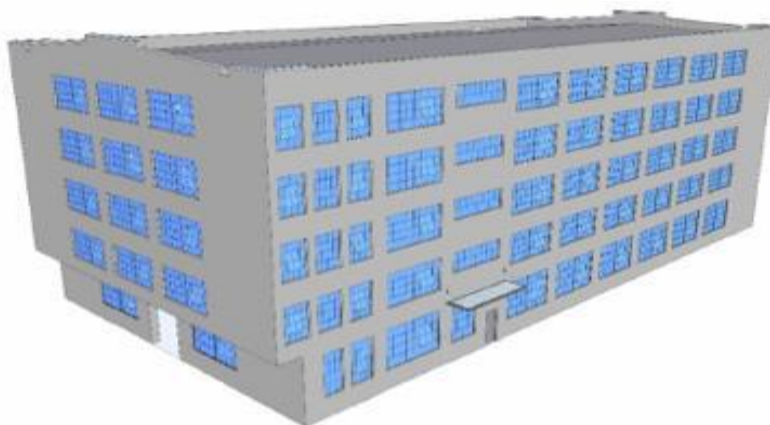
Edificación con discontinuidad fuera del plano debido a que los pisos sobre la planta baja se encuentran en voladizo.
